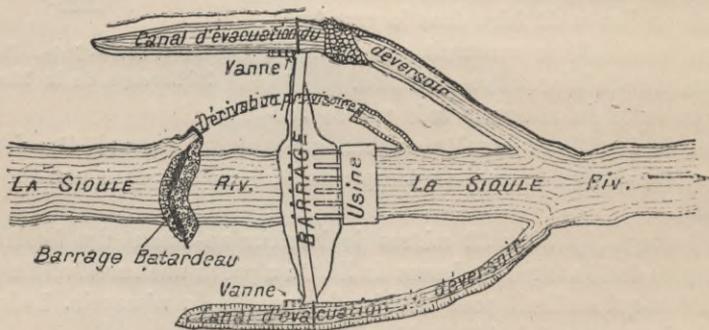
Plan du barrage en construction sur la Sioule (Puy-de-Dôme).
